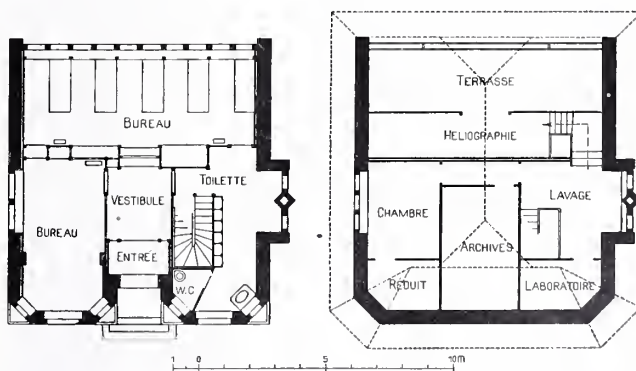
und 4. Grundrisse vom Erdgeschoss und Dachstock.
